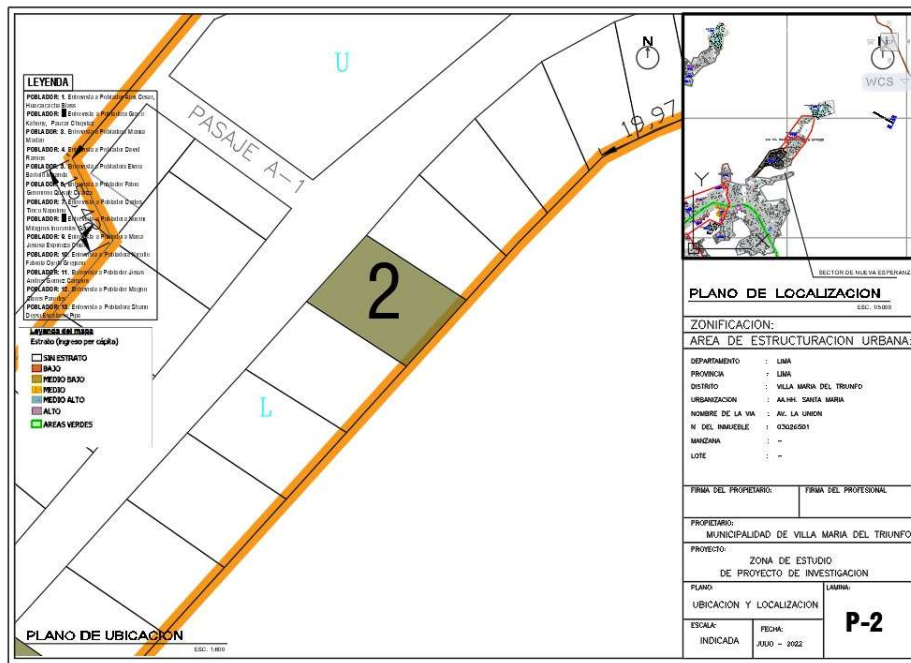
Plano de Ubicación de Casa del Señor Alex Cesar, Huacaicacha Blass
